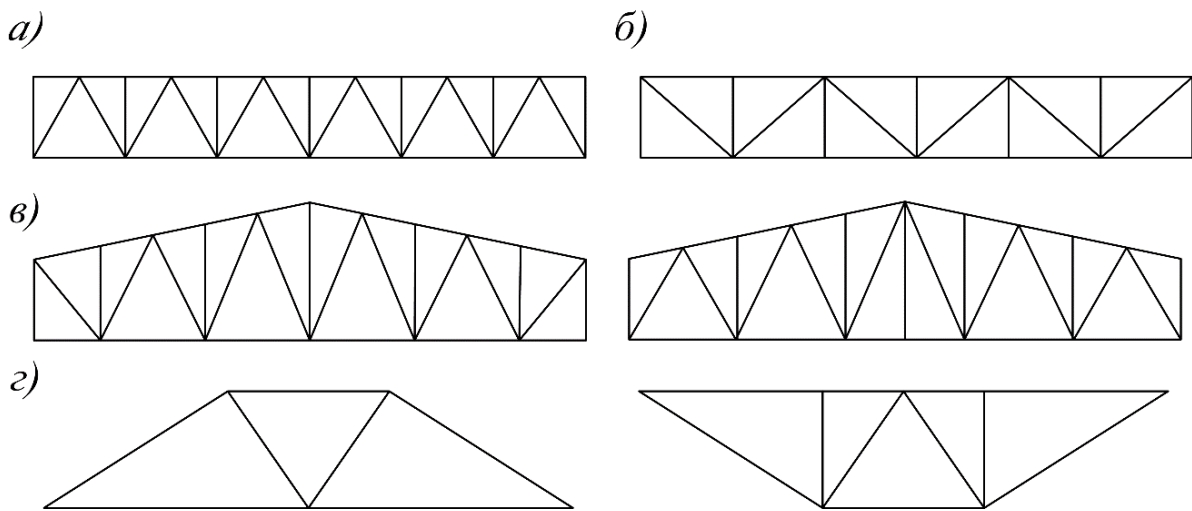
Очертания поясов и элементы ферм: а – с параллельными поясами; б – с треугольной решеткой и дополнительными стойками; в – полигональная; г – трапециевидная
